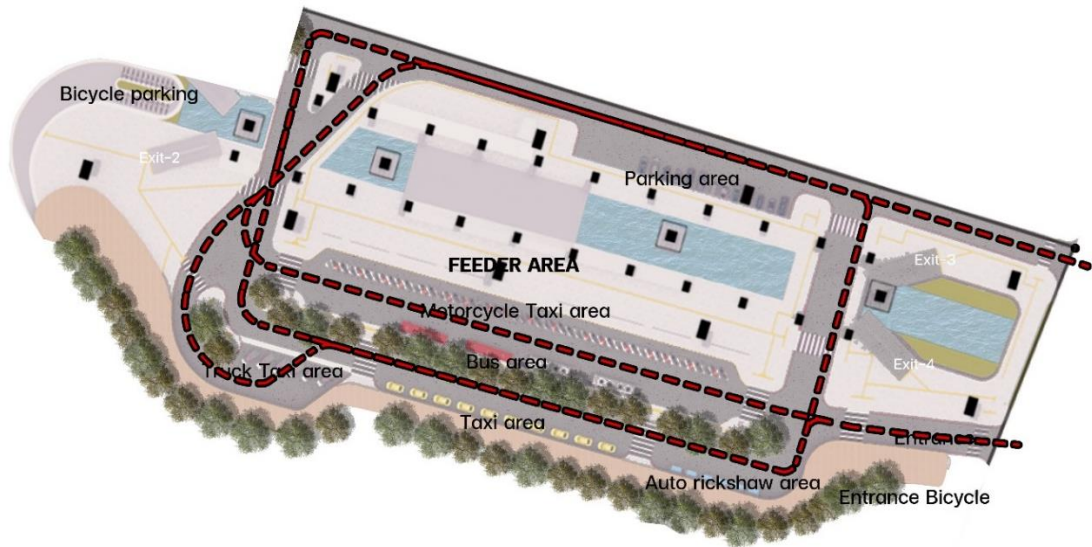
รูปผังแสดง MASTER PLAN
